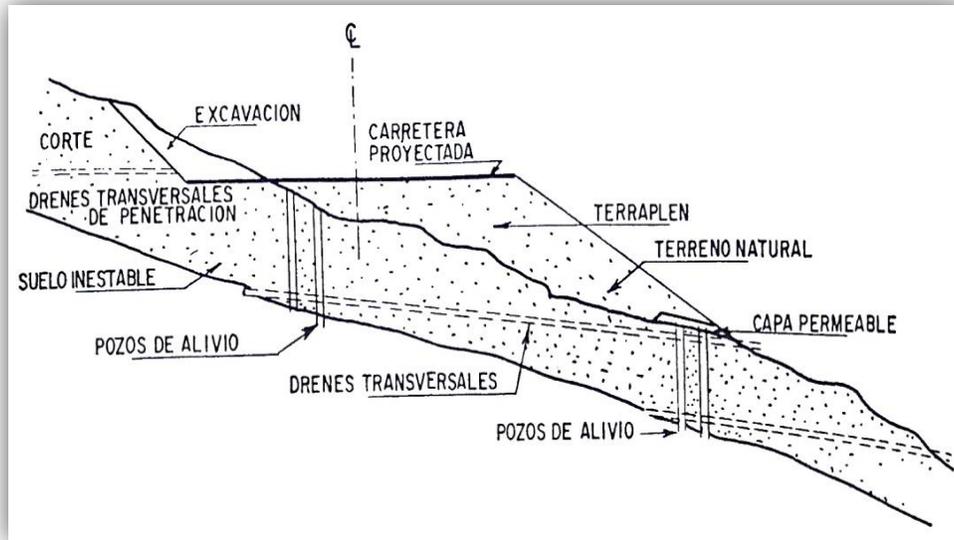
Pozos de alivio combinados con drenes transversales de penetración (ref. 18).
